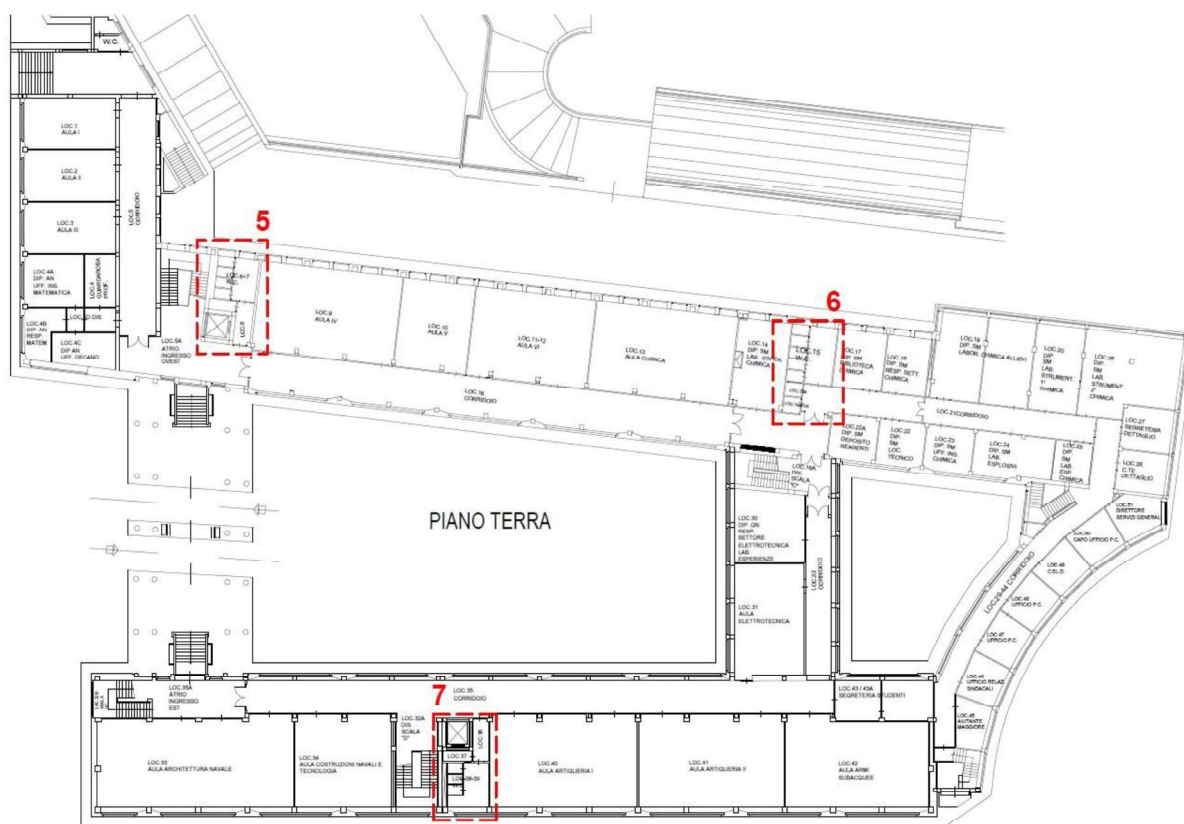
Planimetria piano terra con indicazione dei servizi igienici oggetto di intervento.
